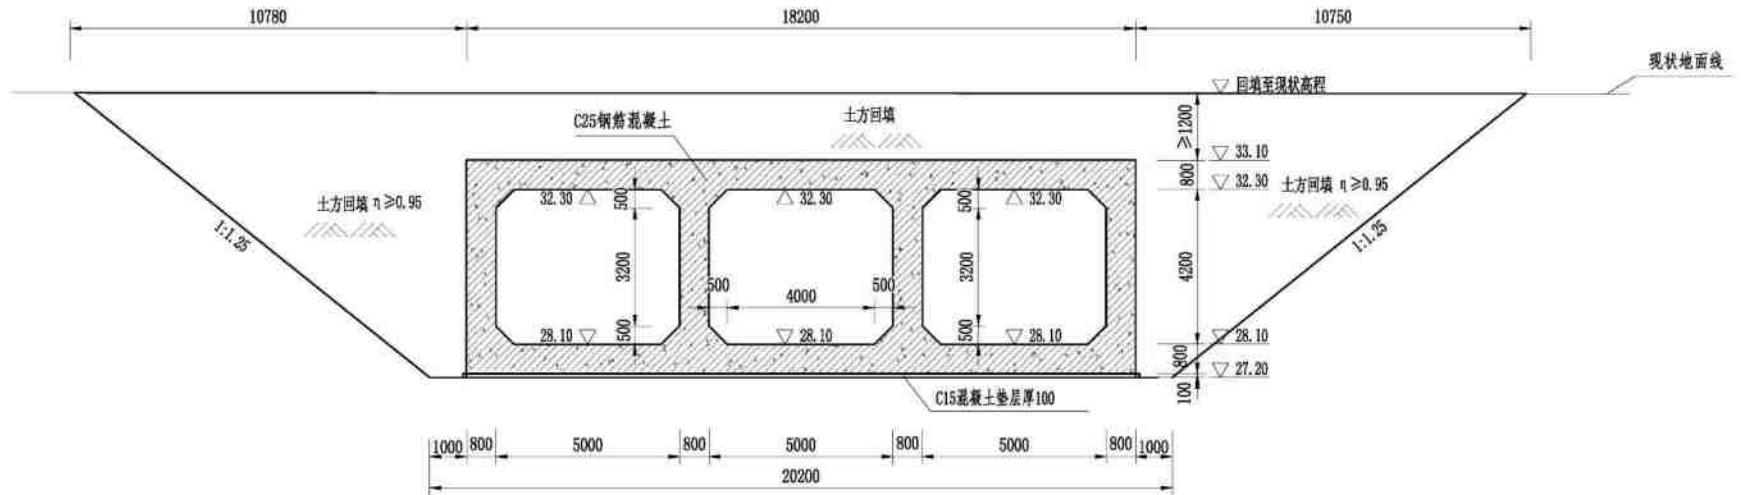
油坊节制闸及箱涵工程箱涵方案断面图
